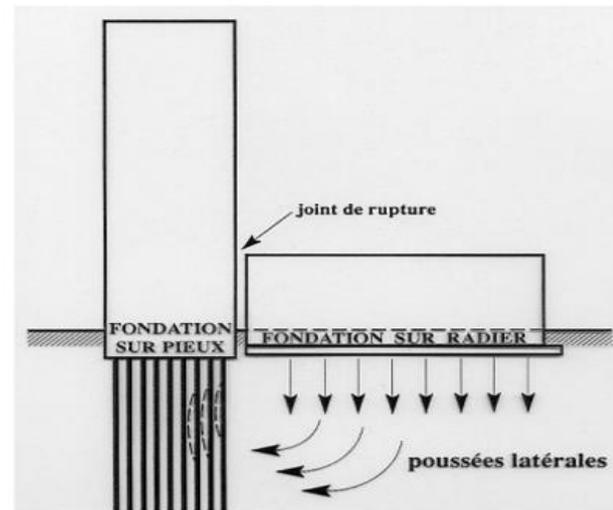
Travaux en sous-sol et/ou constructions voisines risque de déstabiliser le bâtiment.
